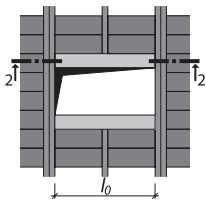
#### DETAIL ŽELEZOBETONOVÉHO PRŮVLAKU VÝMĚNY
